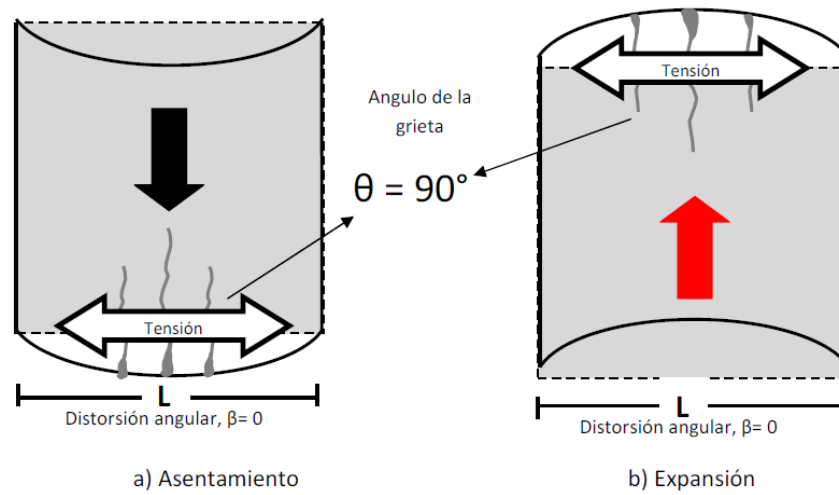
Grietas debido a movimientos verticales en un eje del pórtico.
